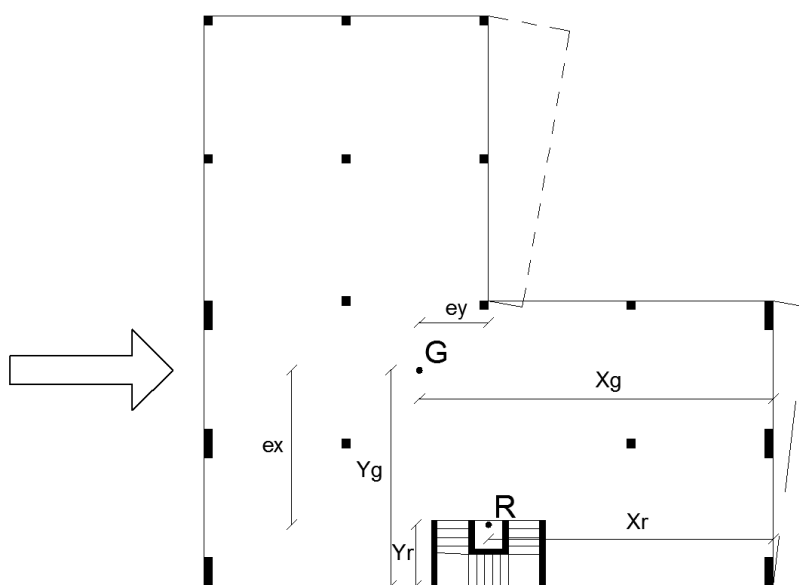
Planta de piso sob ação de uma força horizontal
